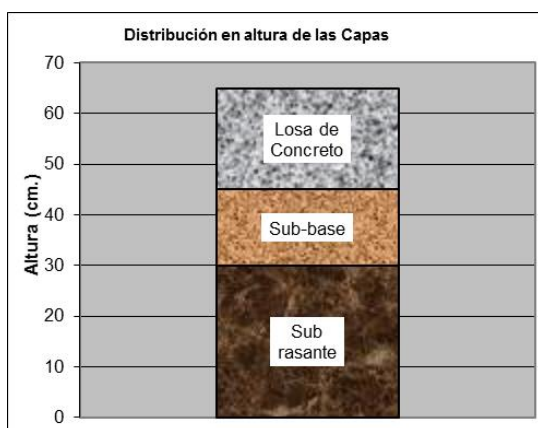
Diseño de pavimento rígido estándar. E=200 mm
